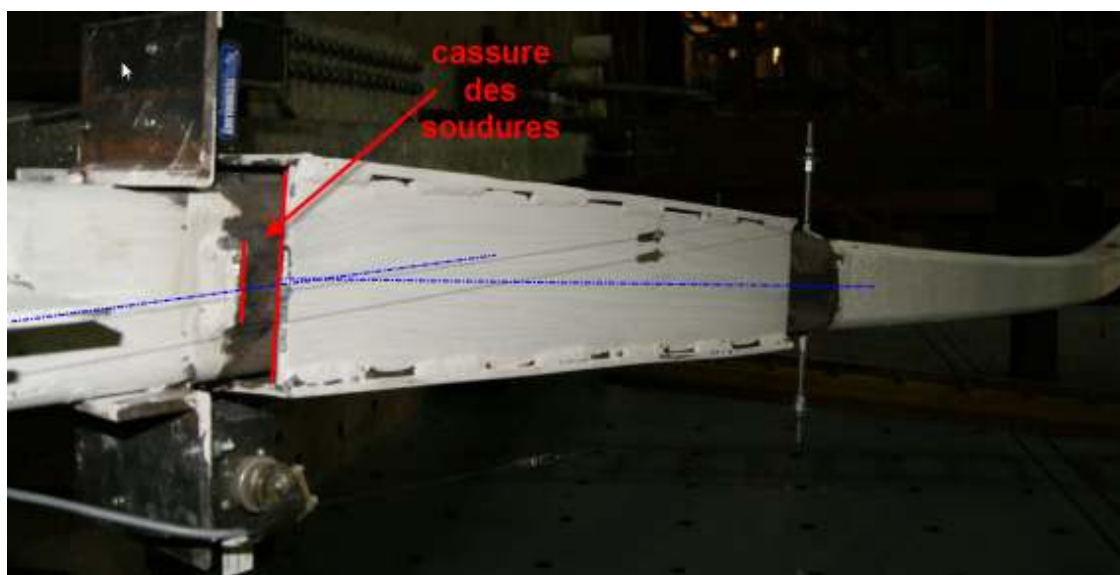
Rupture des soudures d'attache de la boîte, HSS4x4x0.313_F-D-P-40-26-500
